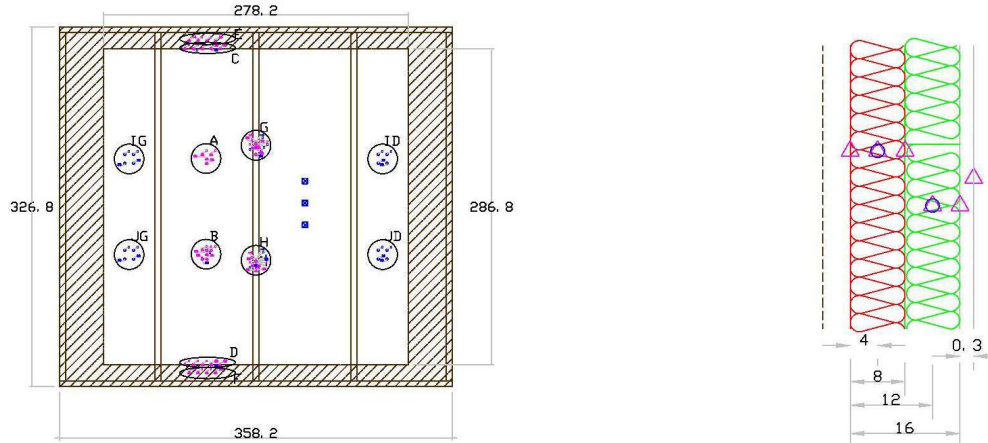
Implantation des capteurs vue de face de la paroi à gauche et vue en coupe de la partie courante à droite (dimensions en cm)
